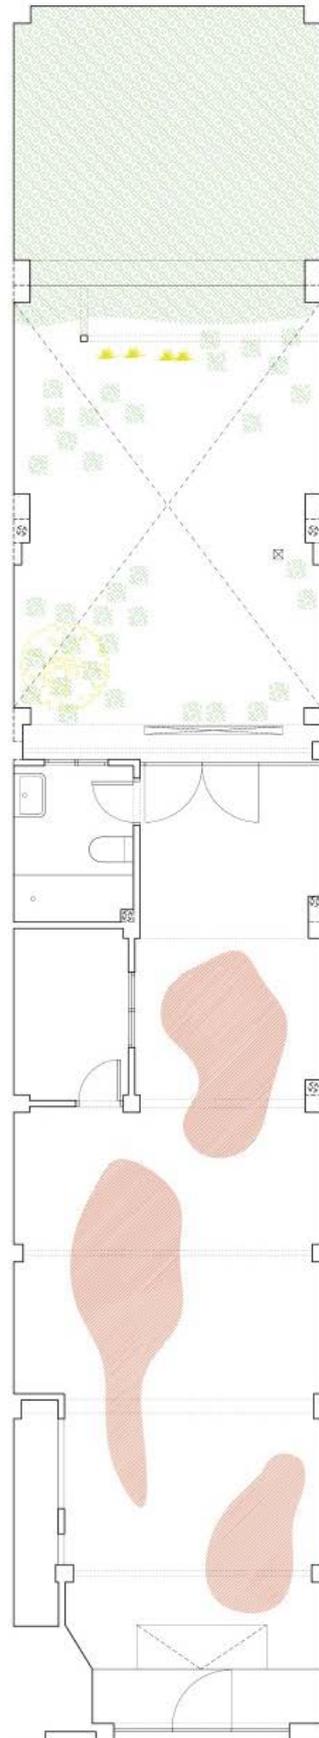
Plano patologías suelos (Plano nº 7, anexo II). Fuente propia.
